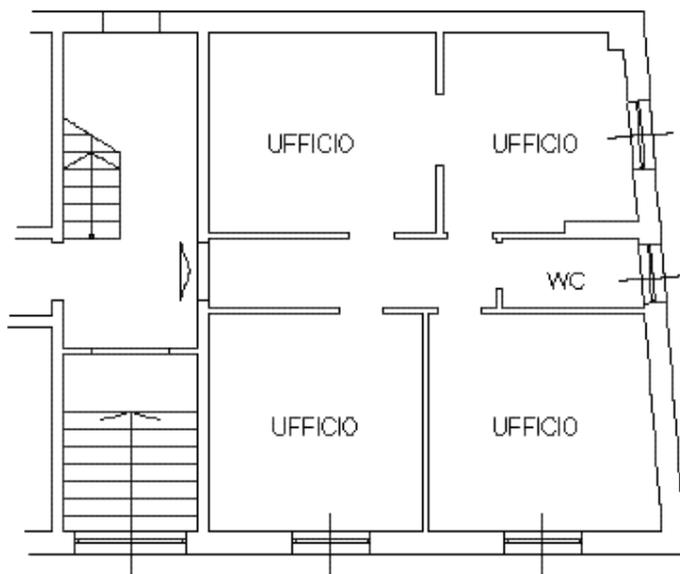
STRALCIO PLANIMETRICO DELL'U.I.U. OGGETTO DI ANALISI (FONTE: INTERNA).
